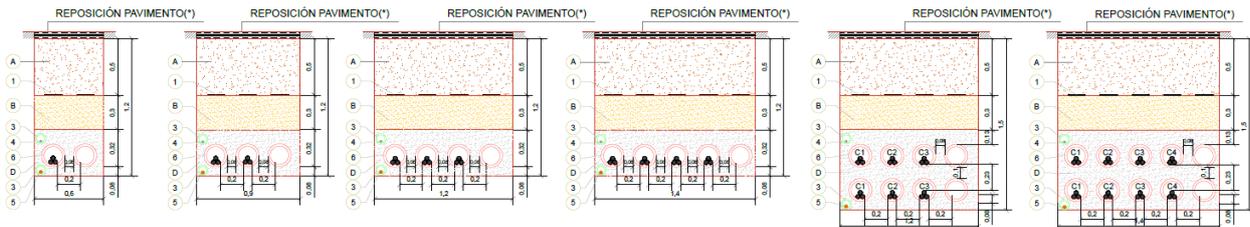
zanjas tipo conductor entubado bajo viales/caminos o drenajes.
